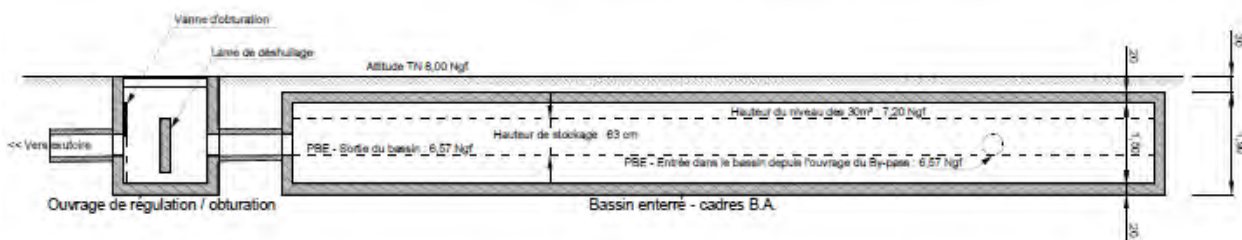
Coupe longitudinale du bassin enterré (Nord)
